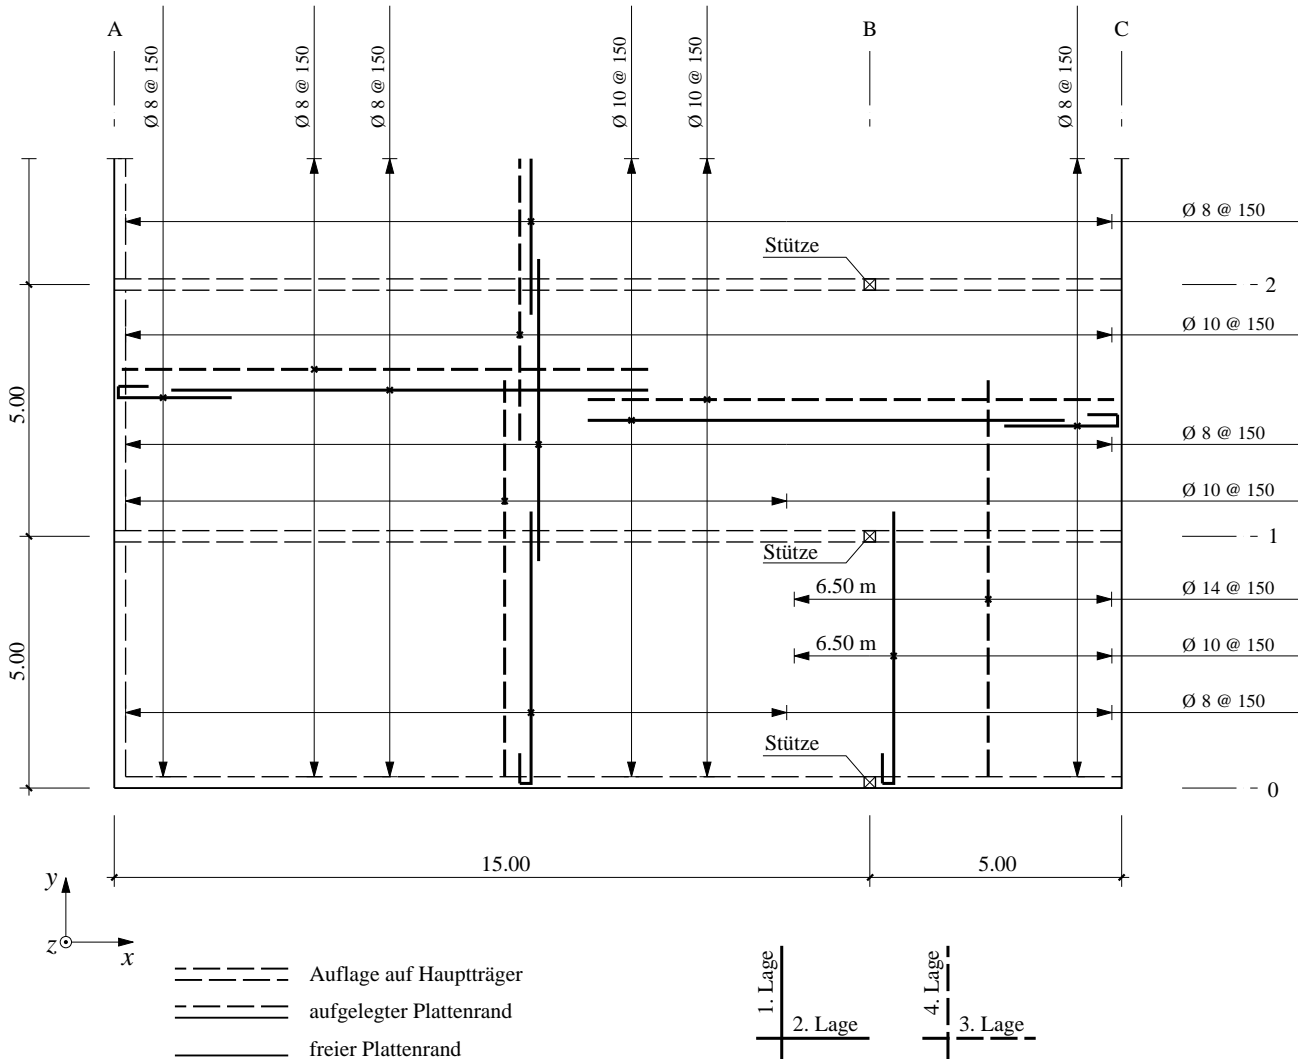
Stahlbetonplatte des Flachdaches der Einstellhalle mit Abmessungen und Bewehrungen zu Aufgabe 2 a)
